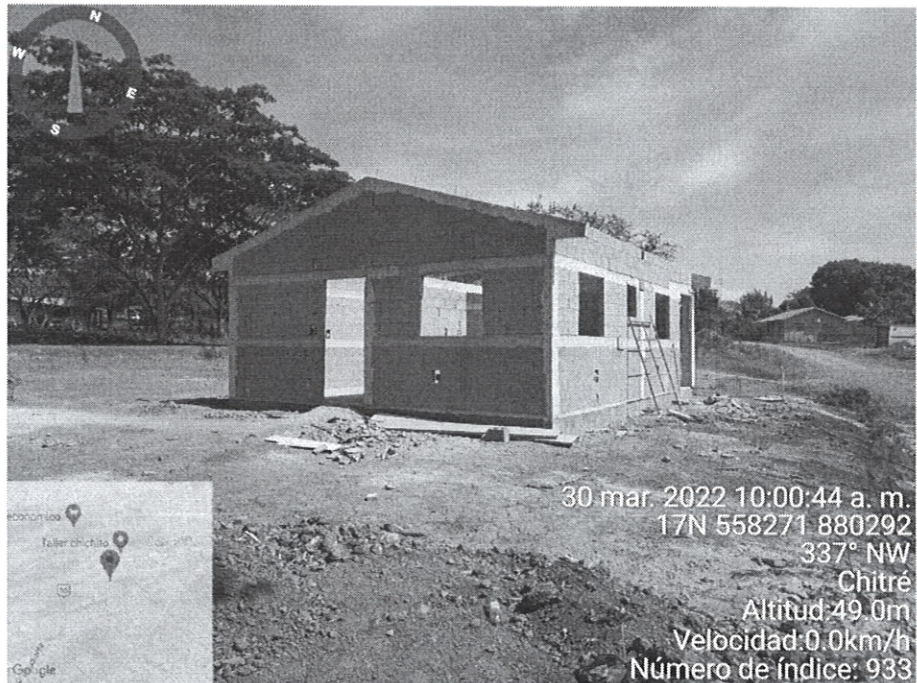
Vista de la residencia construida en el área del proyecto.
